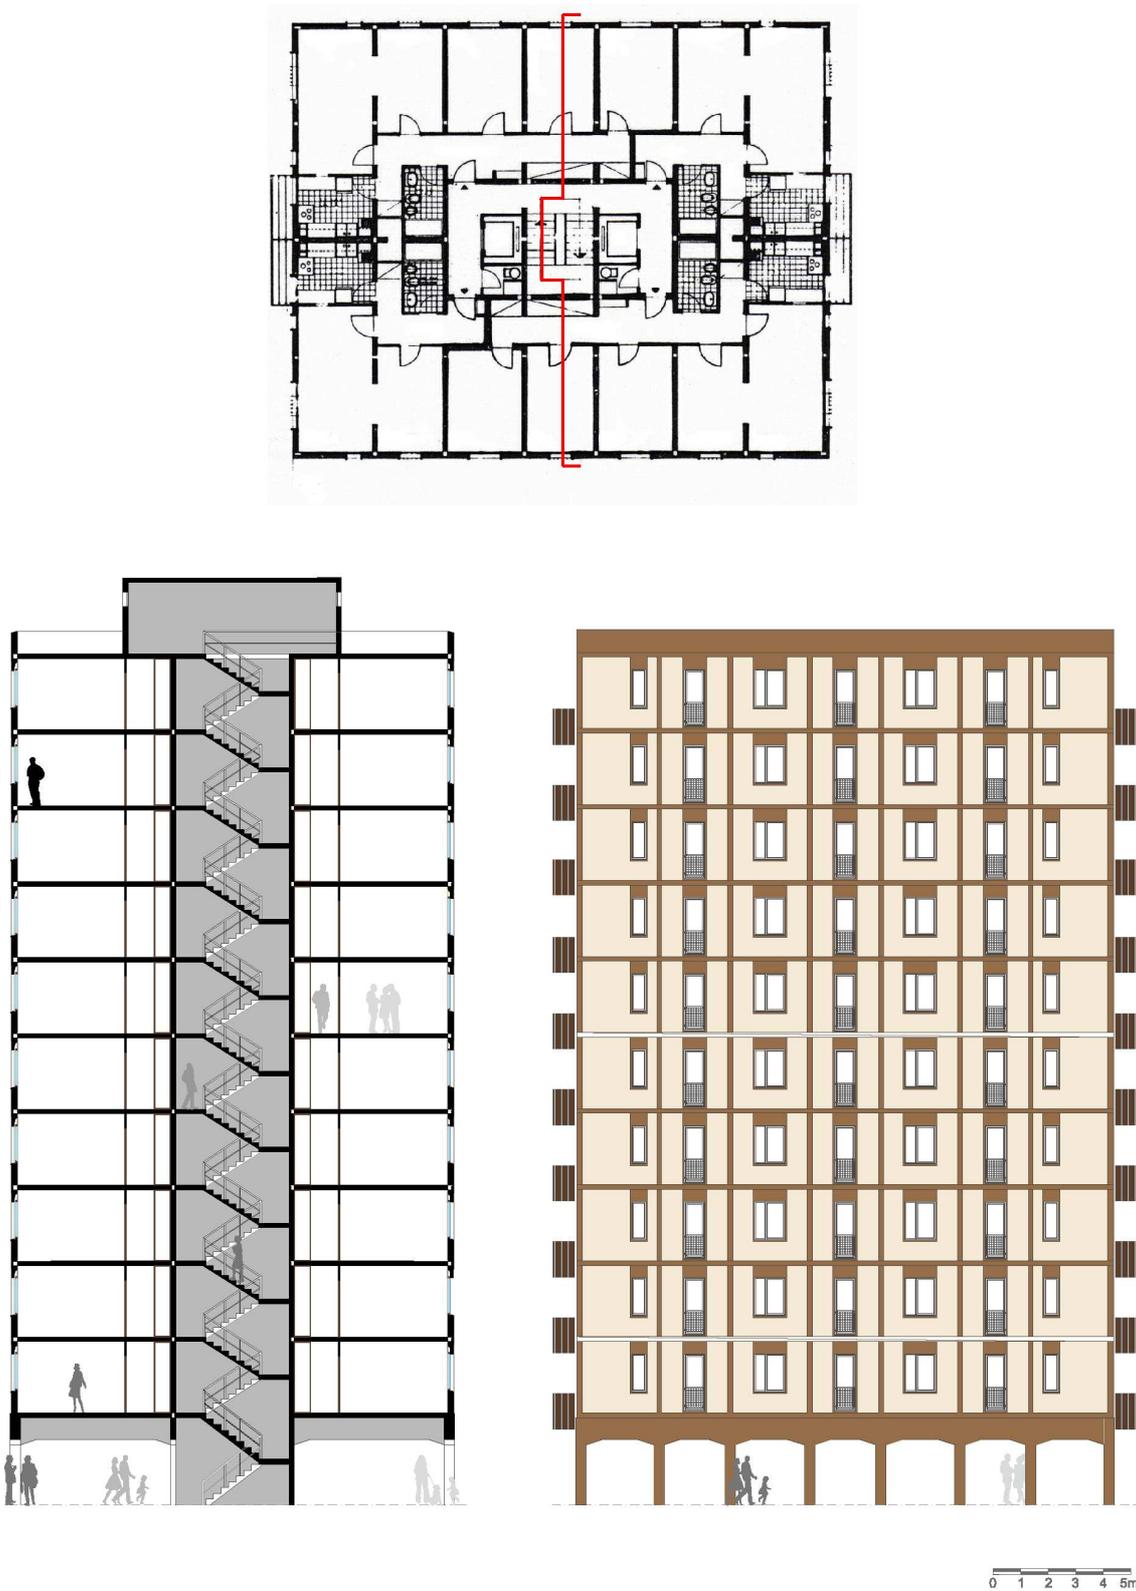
Planta, corte e alçado principal\_ It1, T1 e T4.
